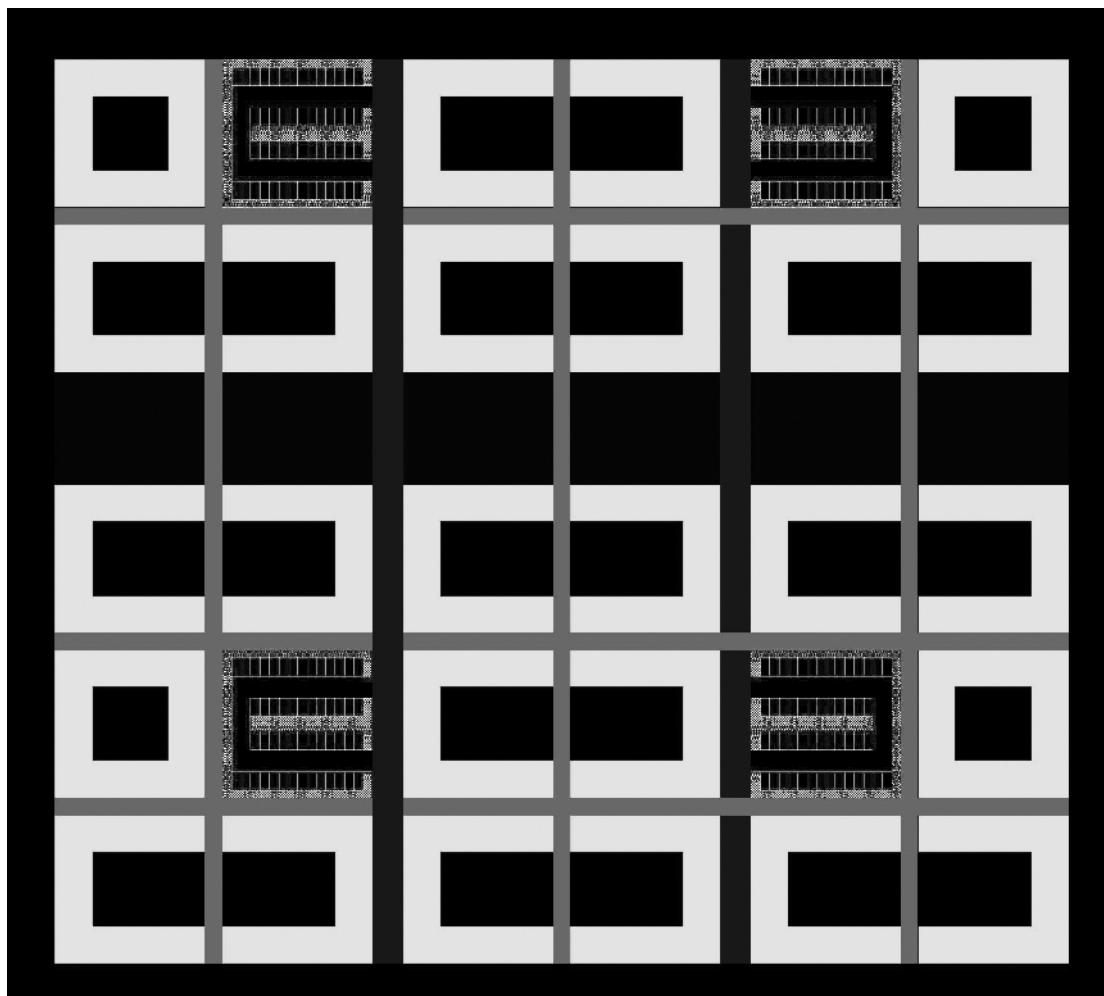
Primeira proposta de sobreposição dos módulos habitacionais no terreno.
